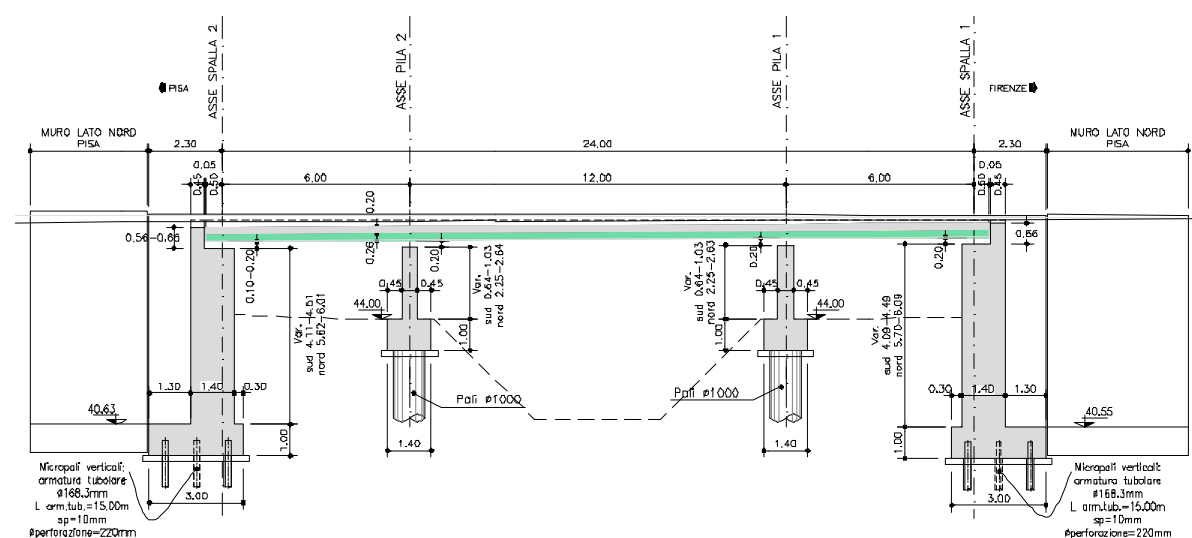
Ponte sul T. Bagnolo Bardena. Sezione longitudinale
